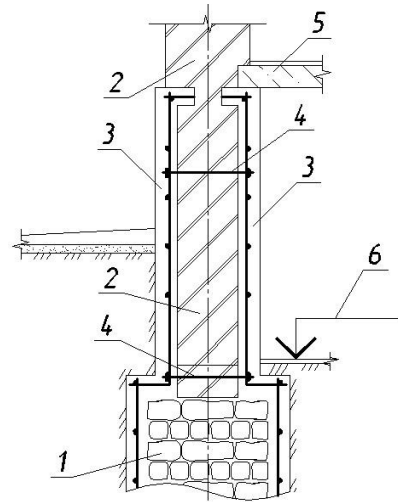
Закріплення стін підвалу й фундаменту улаштуванням залізобетонної обойми:
